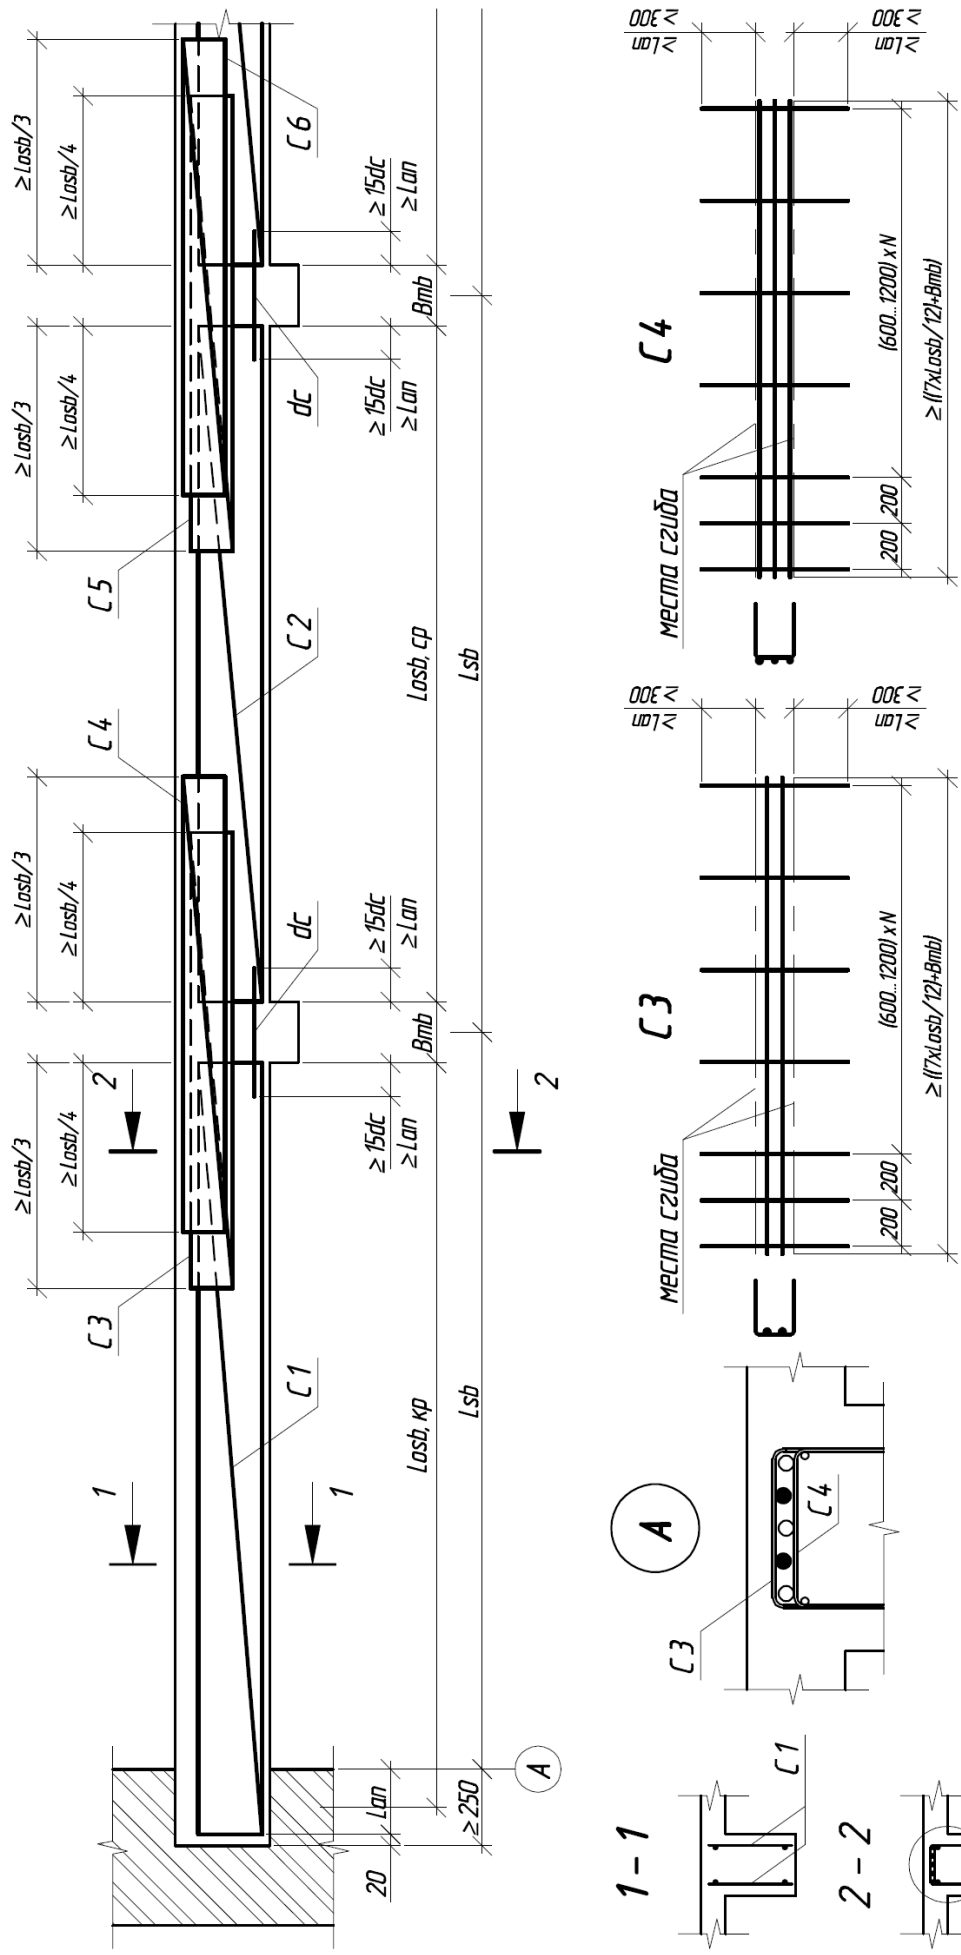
Схема армирования монолитной восторепенной балки сварными каркасами
